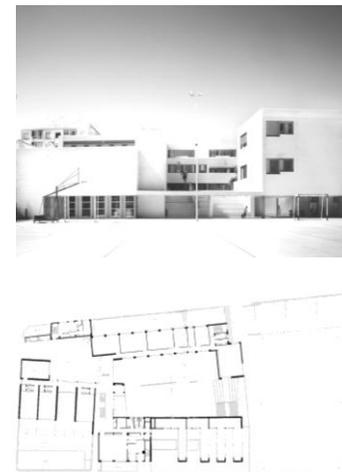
Imagen externa y planta CEIP Carolina Sala.
